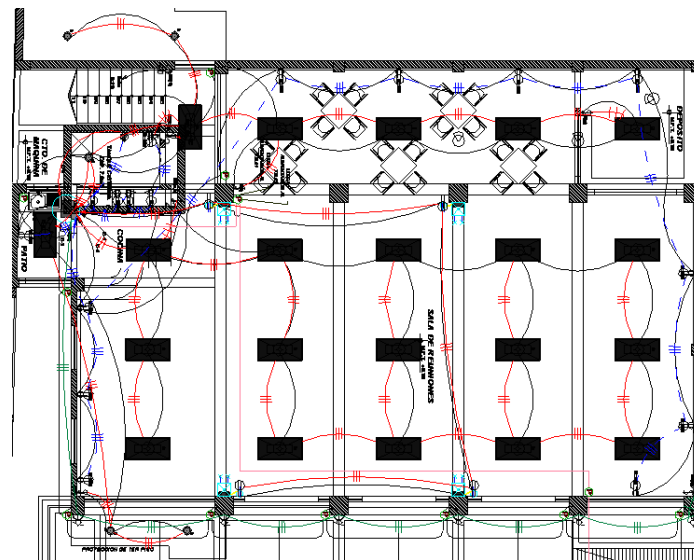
Plano de cableado - Sótano. Fuente: Autor.
